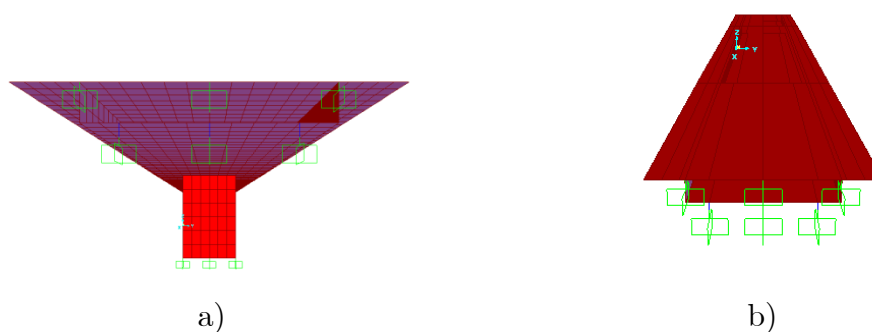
Vista da secção transversal do pilar: a) vista inferior; b) vista superior.
